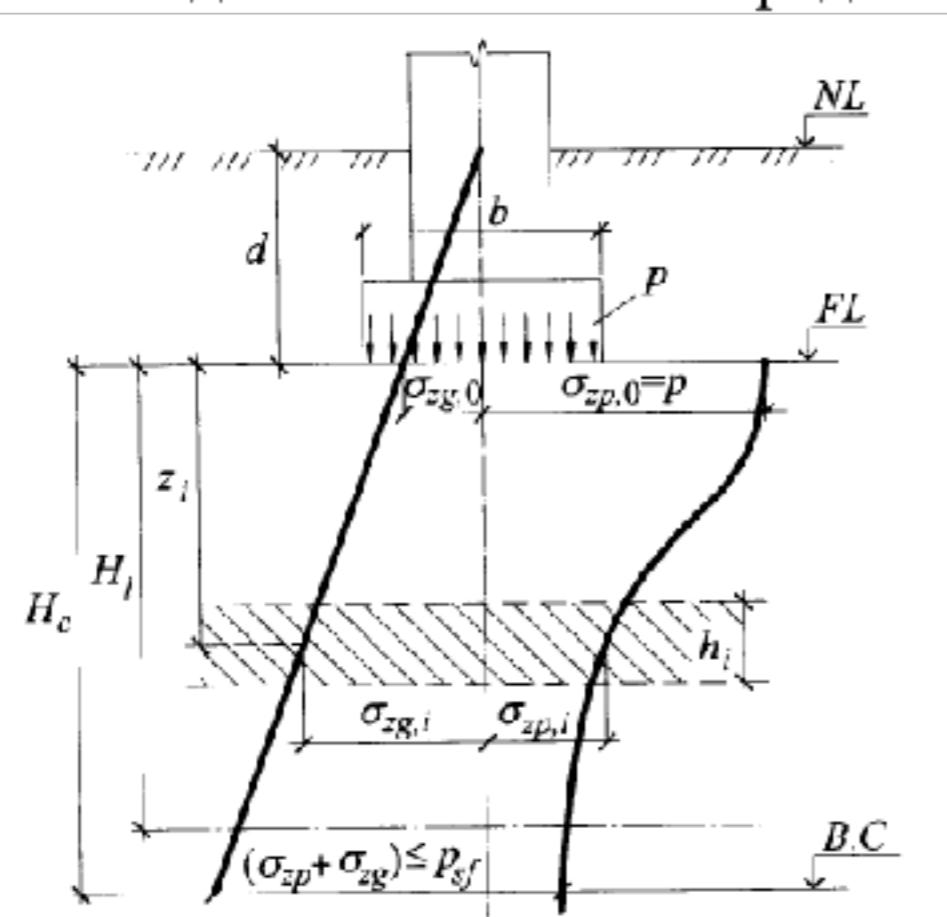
Схема для расчета суффозионной осадки засоленного грунта при вертикальной фильтрации
